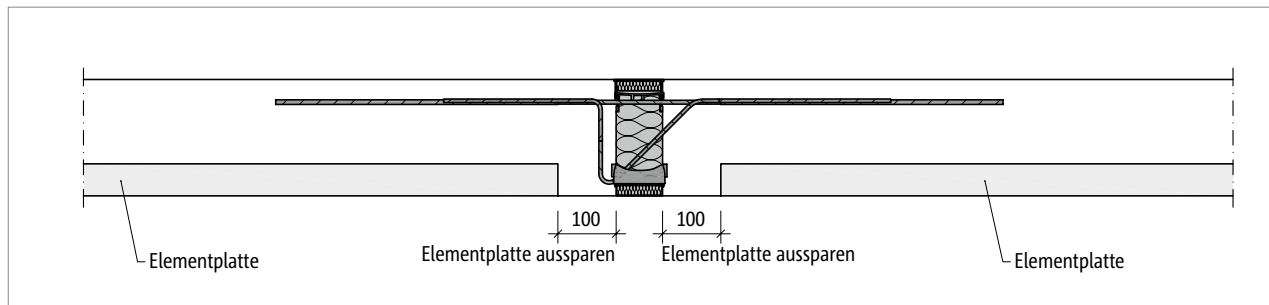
Schöck Isokorb® T Typ KL: Einbau in Verbindung mit Elementplatten, Druckfuge deckenseitig und balkonseitig
